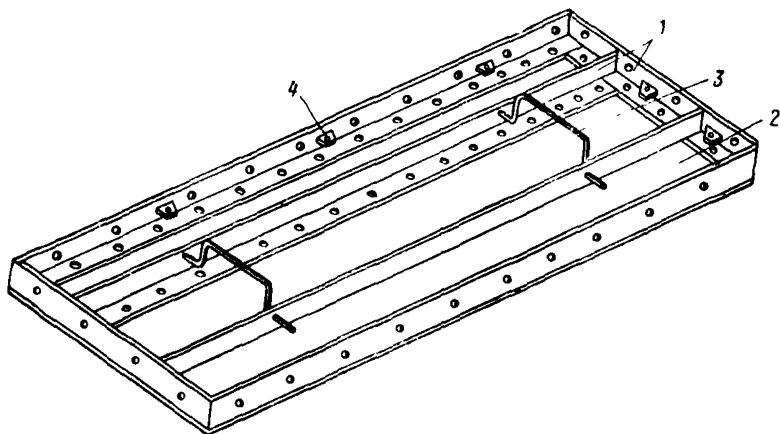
Общий вид опалубочного щита конструкции Минмонтаж-спецстроя
